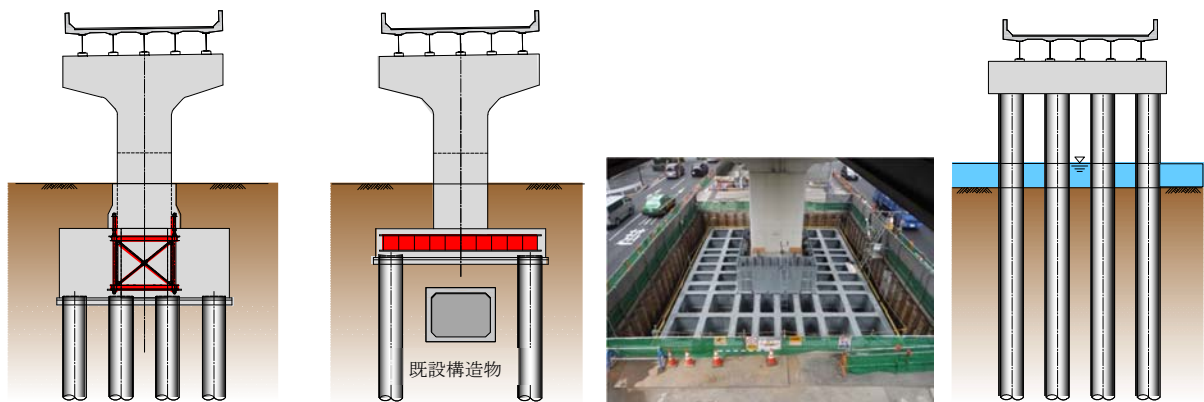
アンカーフレーム構造 図-2 合成構造フーチング 写真-1 鋼製格子部材 図-3 パイルベント橋脚
